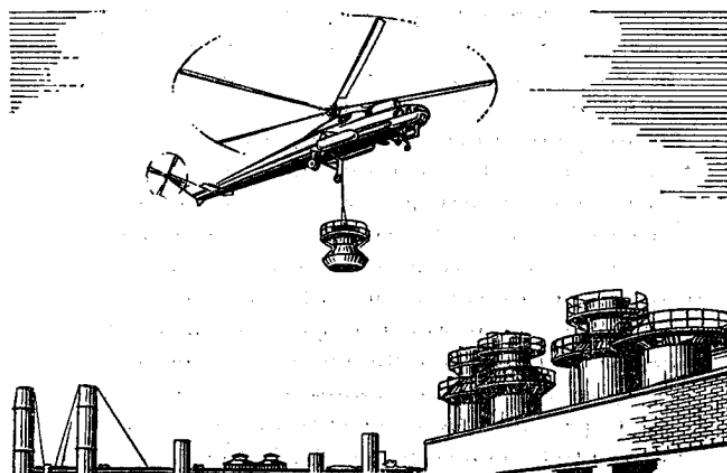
Замена искрогасителей вагранок с использованием вертолета МИ-10К
